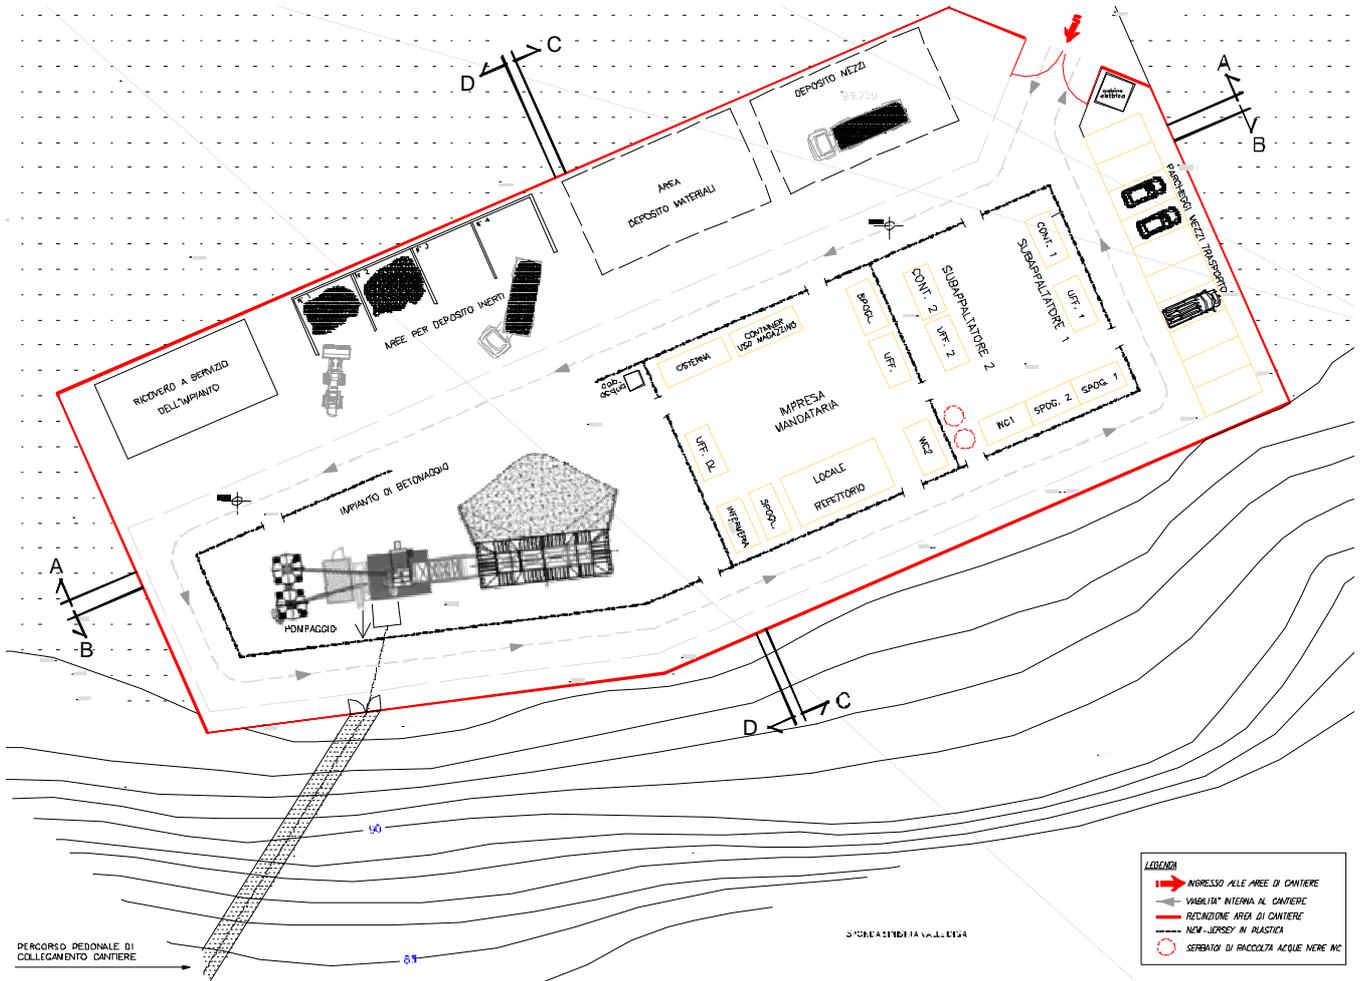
Organizzazione dell'area di cantiere in sponda sinistra
